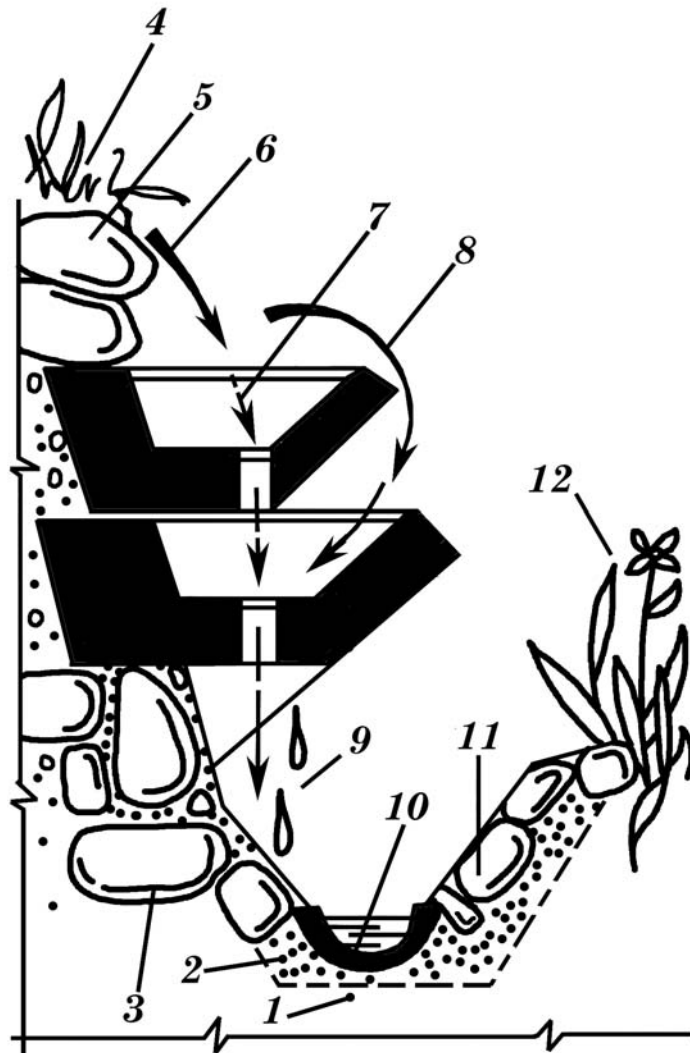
Пример укрепления разрушающегося склона с помощью керамических блоков (поперечный разрез стенки): 1 – грунт основания; 2 – песчано-гравийное основание; 3 – камень-лежень; 4 – дерновый слой; 5 – бордюрный камень-лежак; 6 – направление сползания мини-селя; 7 – направление стока воды; 8 – слив излишней селявой воды; 9 – сток воды в водоотводный лоток; 10 – лоток; 11 – бортовой камень; 12 – растения.
